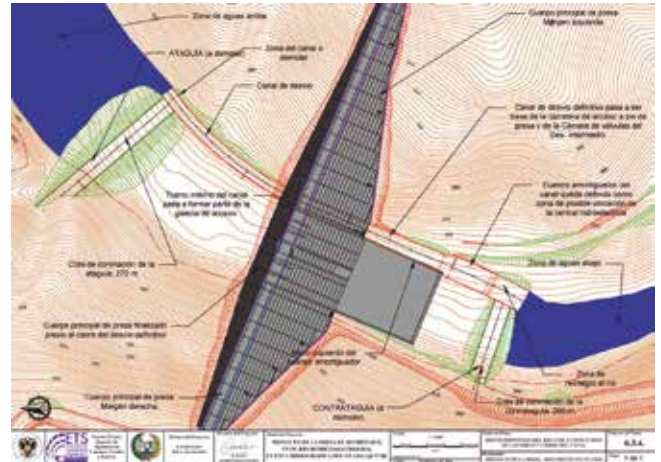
Planta de las obras durante la fase de desvío definitivo
